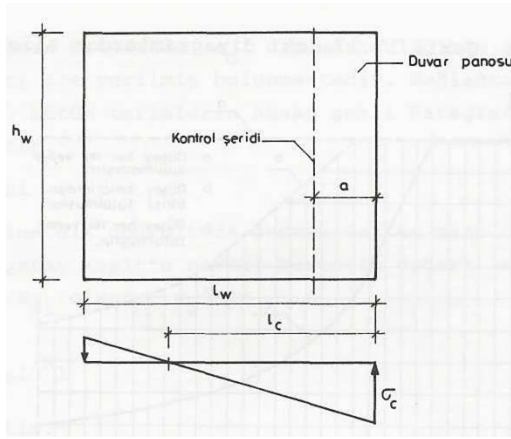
Betonarme Panolarda Tekil Yükün Yayılışı
